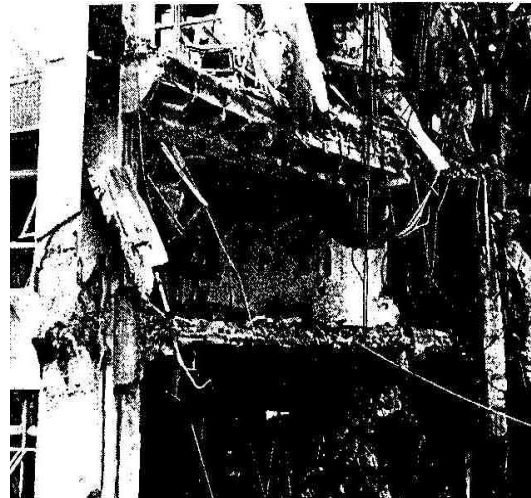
Detalle de la ruina de la estructura de hormigón del edificio Sede II de CESP
